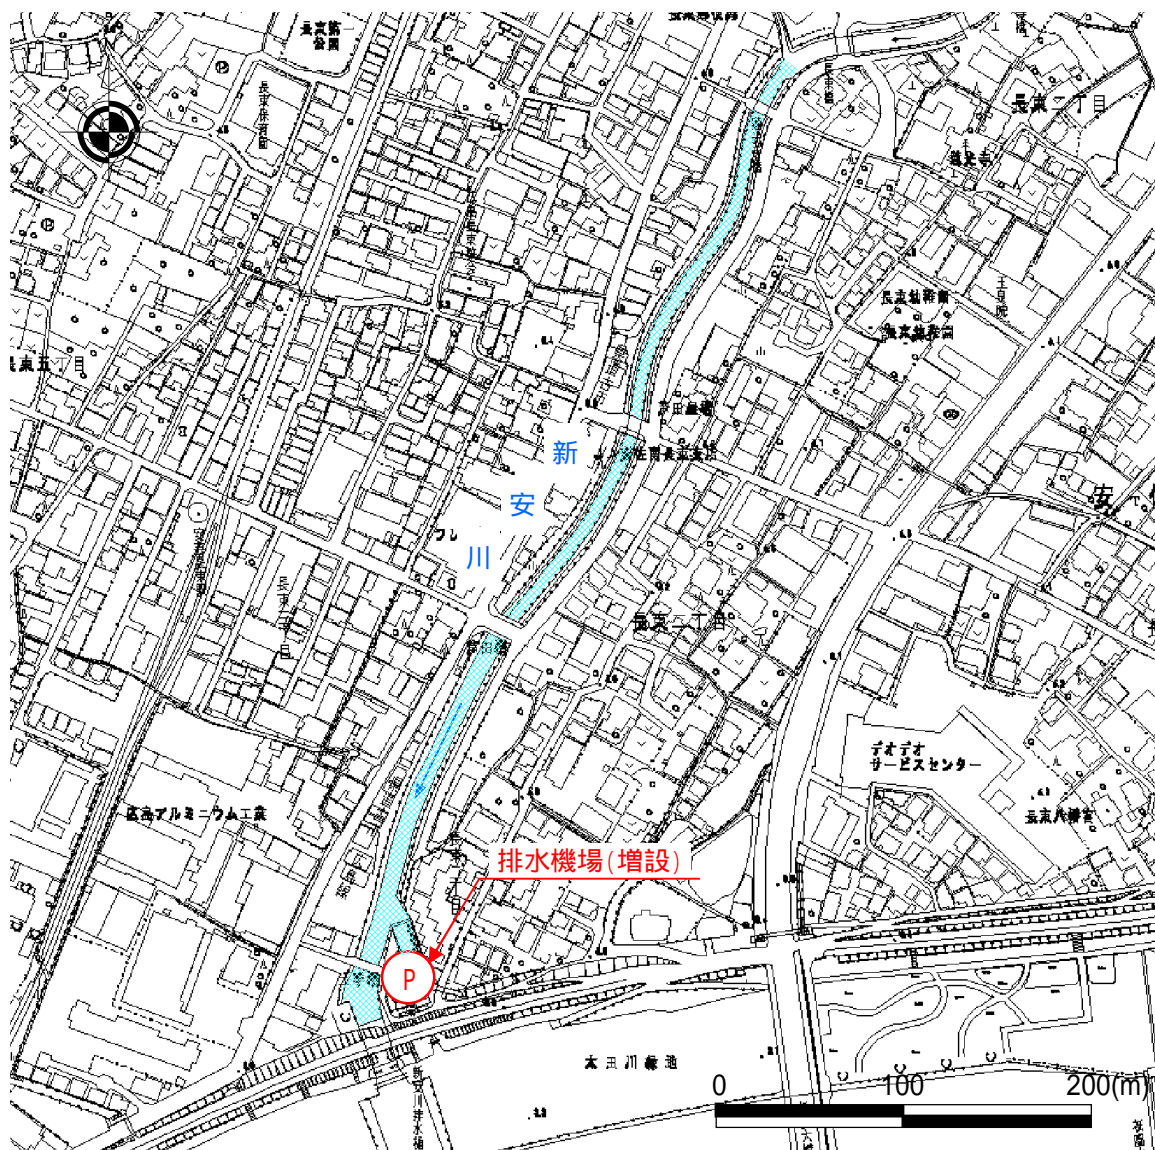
(1) 平面図(新安川) (S=1 : 4,000)
